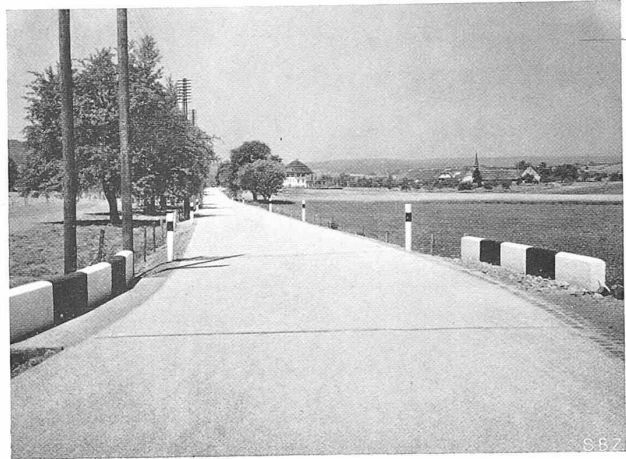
Betonstrasse bei Schlatt, Richtung Schaffhausen.
